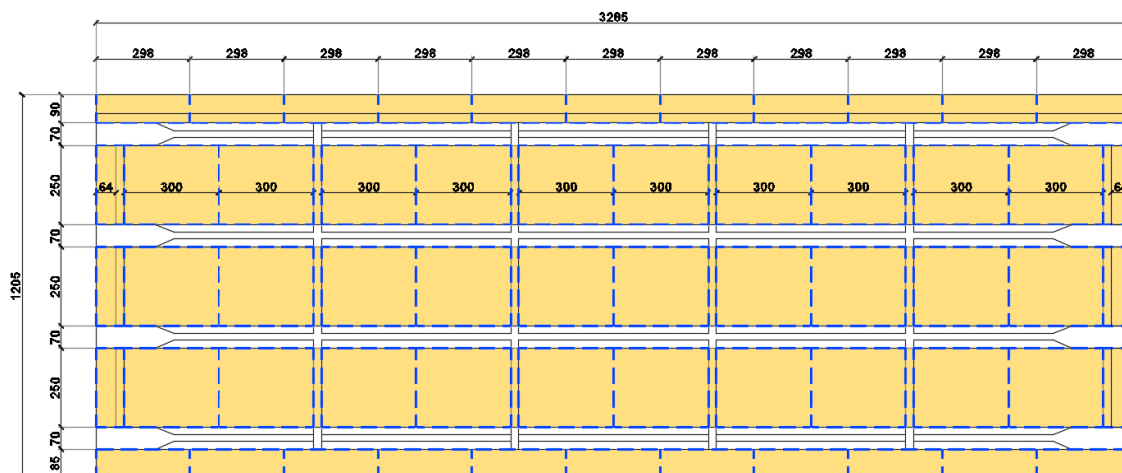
Planimetria alleggerimenti carreggiata tipo
